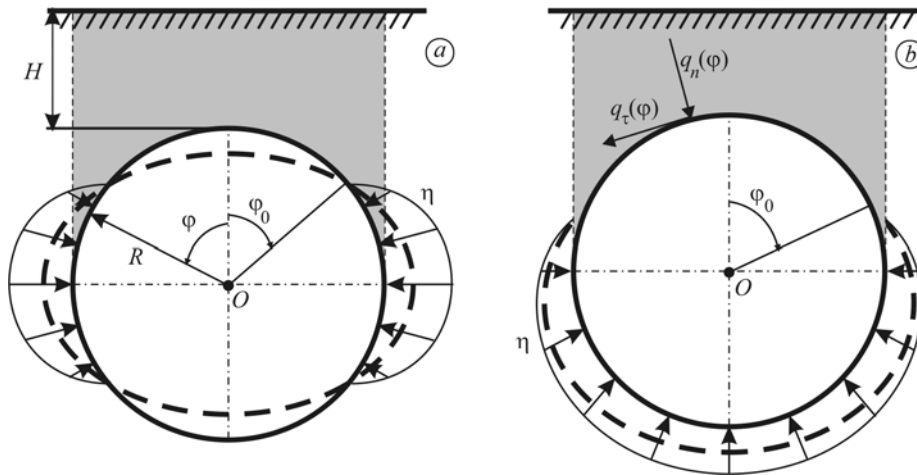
Схеми навантаження стільникової труби (поперечний переріз):
